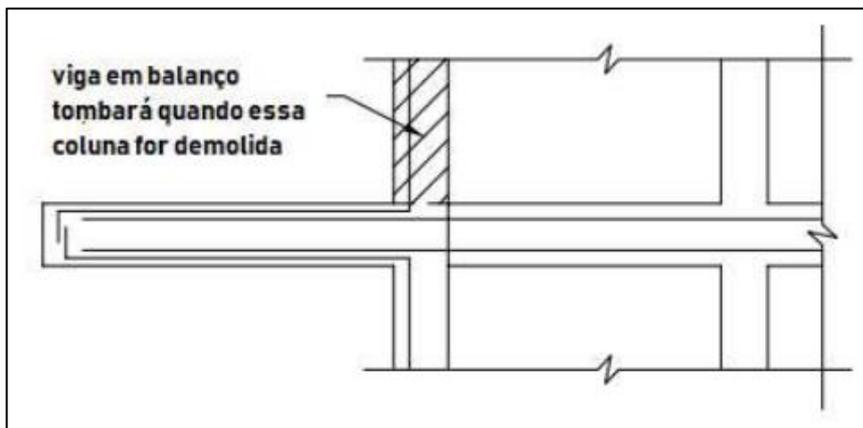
Tombamento de viga em balanço com a remoção de pilares. (fonte: BUILDINGS DEPARTMENT, 2004)
